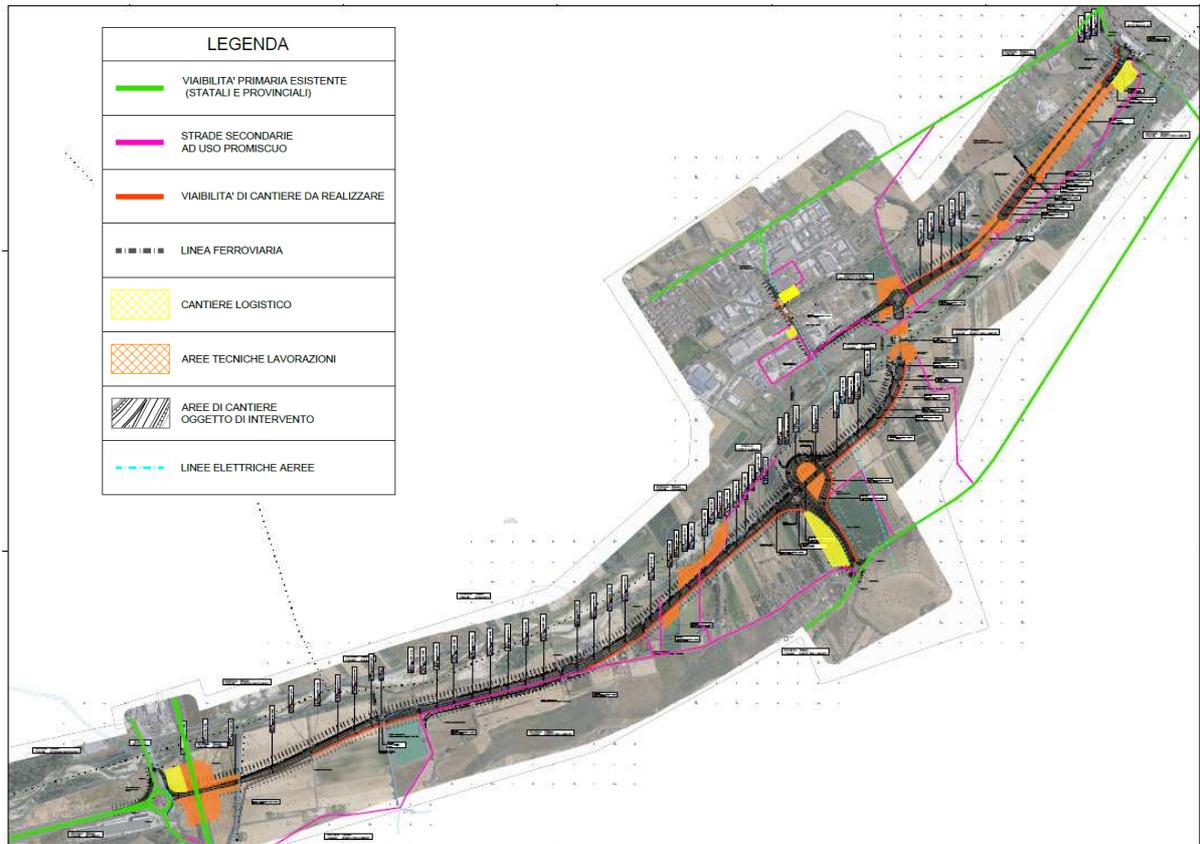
Stralcio elaborato T00CA00CANPP01_A: Planimetria generale aree di cantiere
